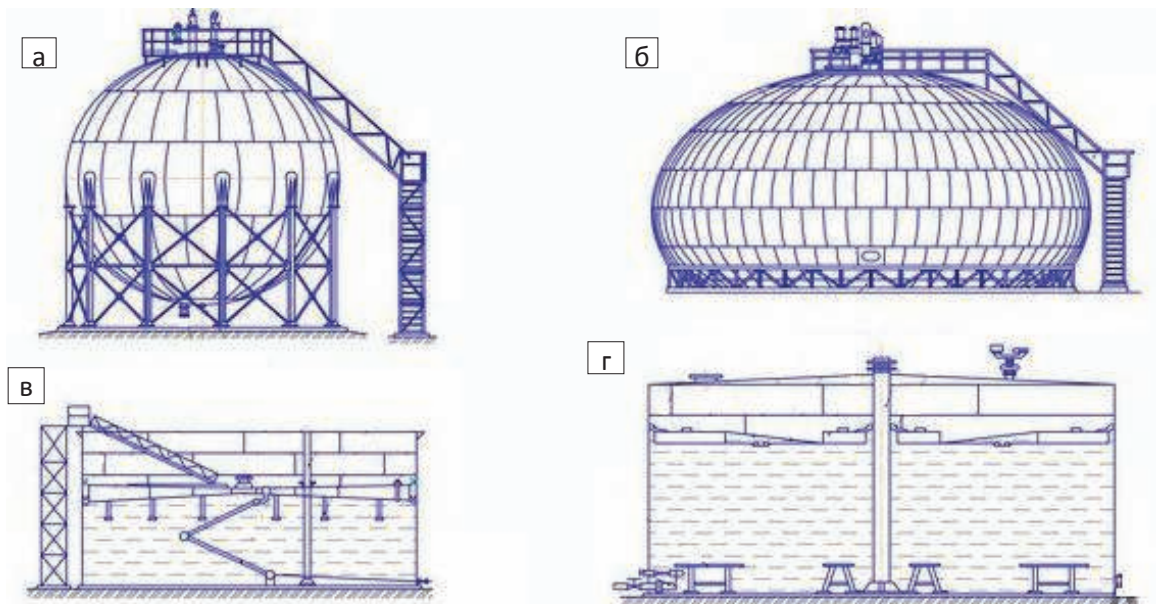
Ёмкости специальной конструкции: а – шаровой резервуар; б – каплевидный резервуар; в – резервуар с плавающей крышей; г – резервуар с плавающим металлическим понтоном
